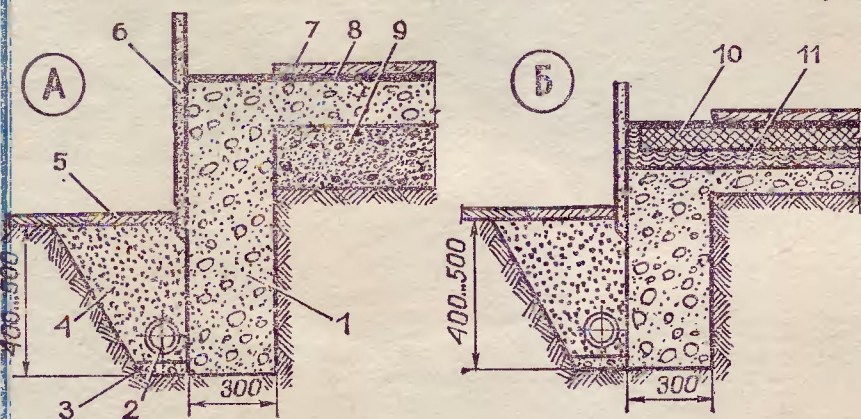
Фундамент (А — с холодным полом, Б — с утепленным):
